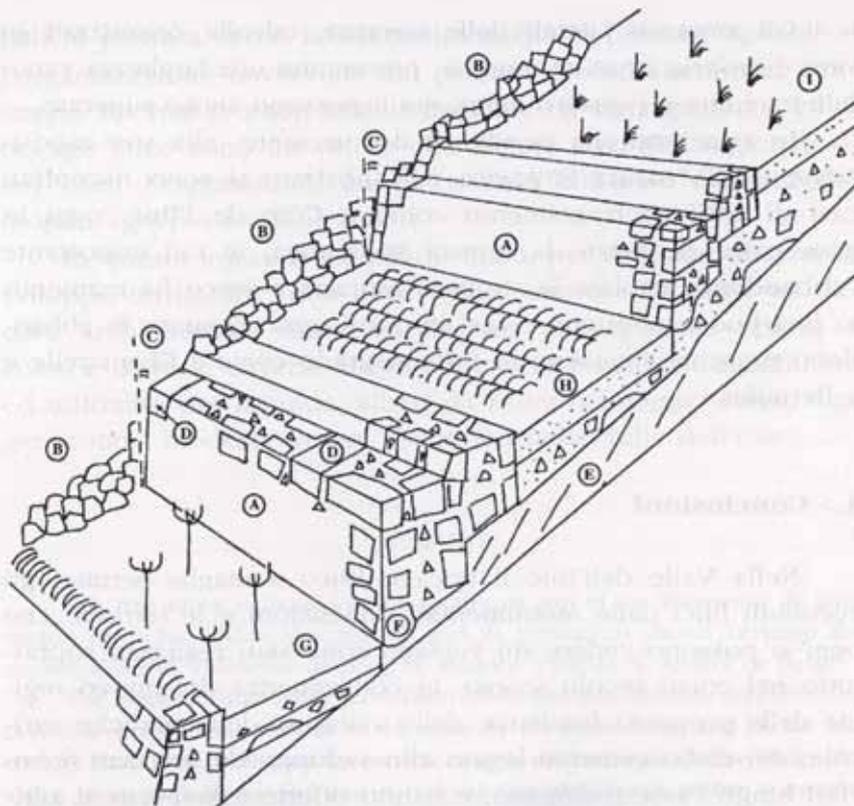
Sezione tipo di un versante terrazzato nella valle dell'Ibrie:
